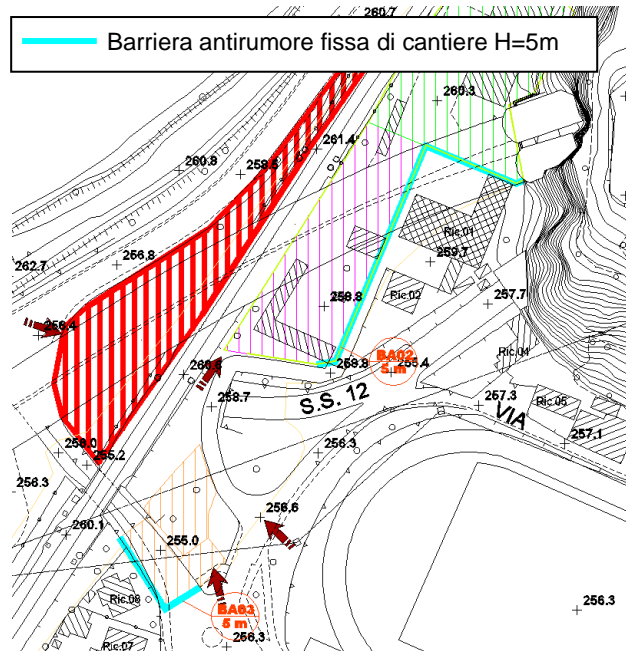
Localizzazione delle barriere antirumore di cantiere BA02 e BA03
